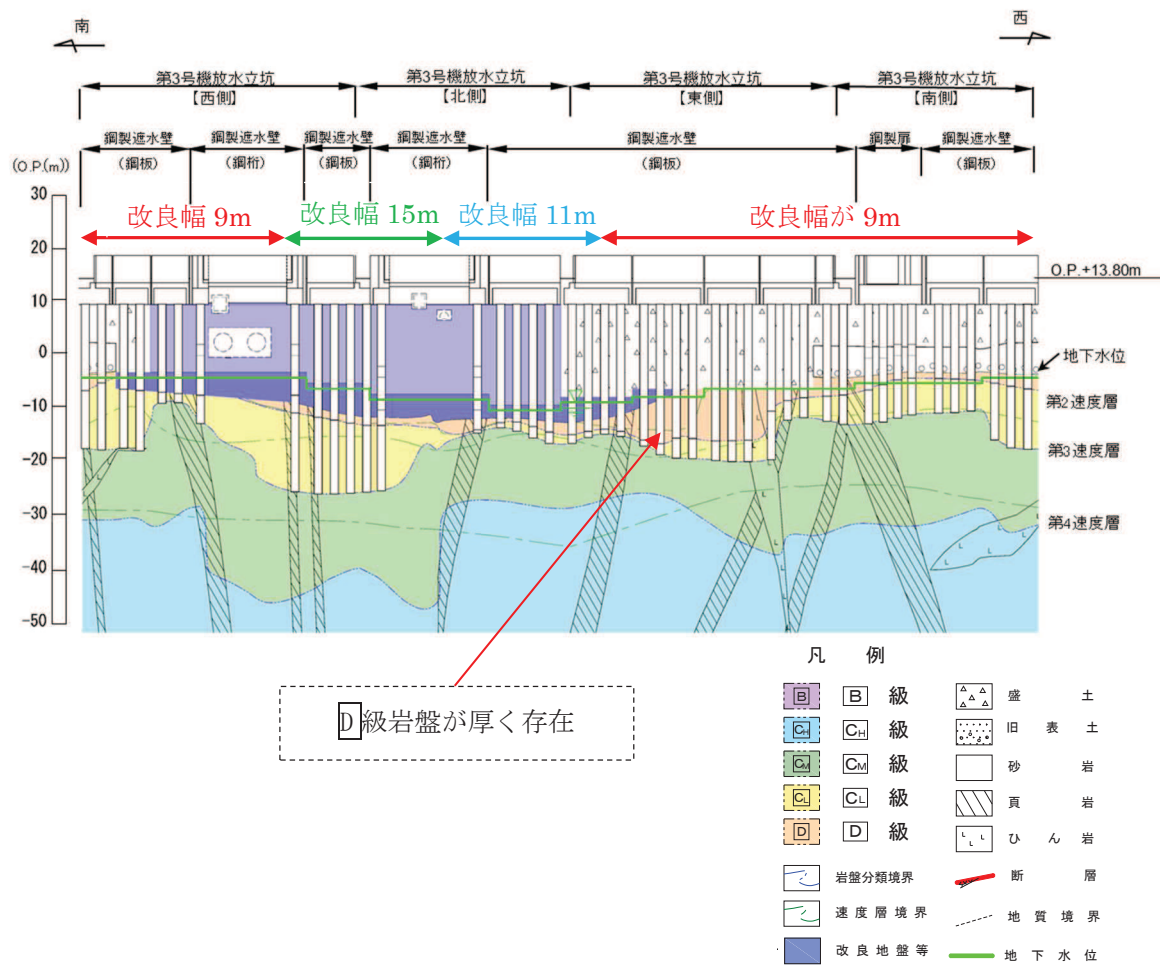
第 3 号機放水立坑防潮壁部 地質縦断面図
